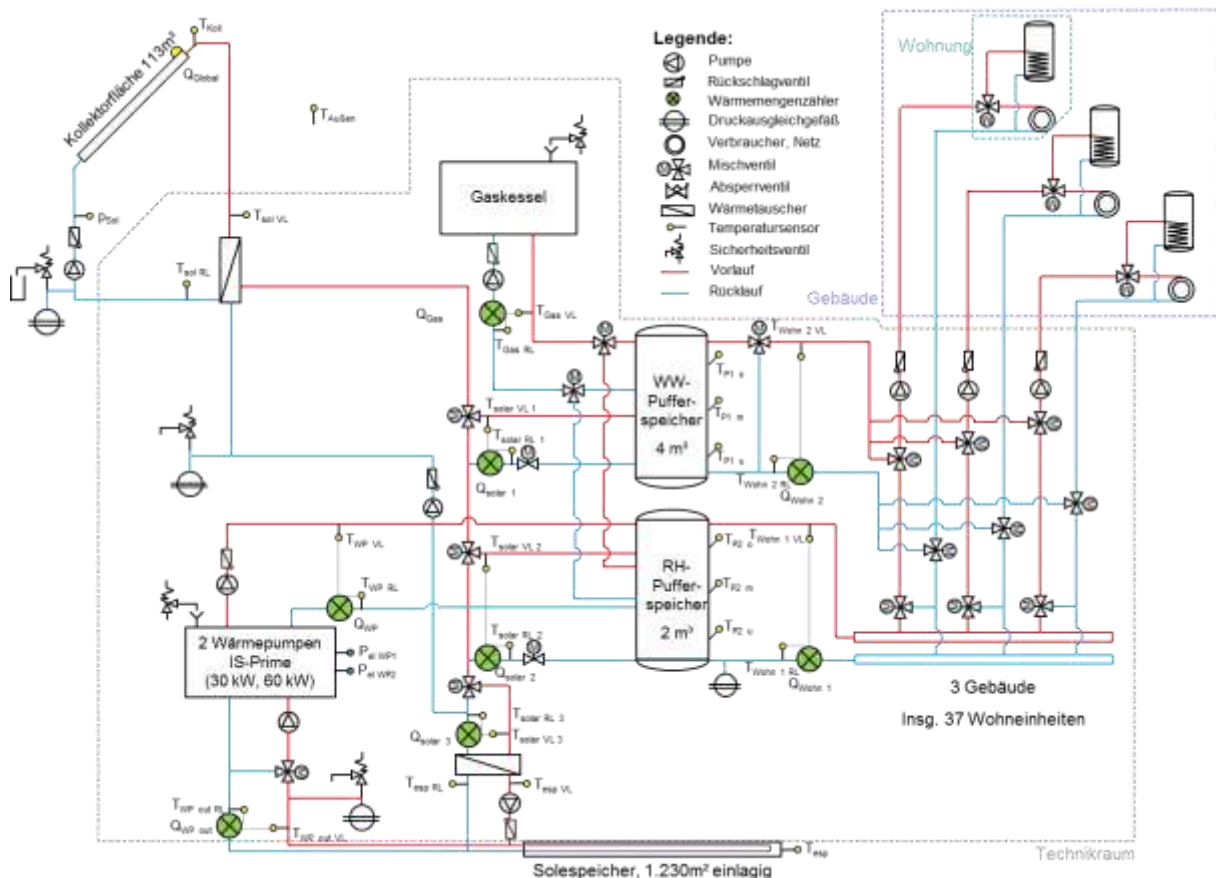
Hydraulik- und Messkonzept zum Bauvorhaben Fuxsteiner & Heimberger OG (grün: Volumenstromzähler; gelb: Temperatur und Einstrahlungssensoren). Die Gebäudegrenzen sind strichliert dargestellt (Gebäude, Technikraum, Wohnungen)
